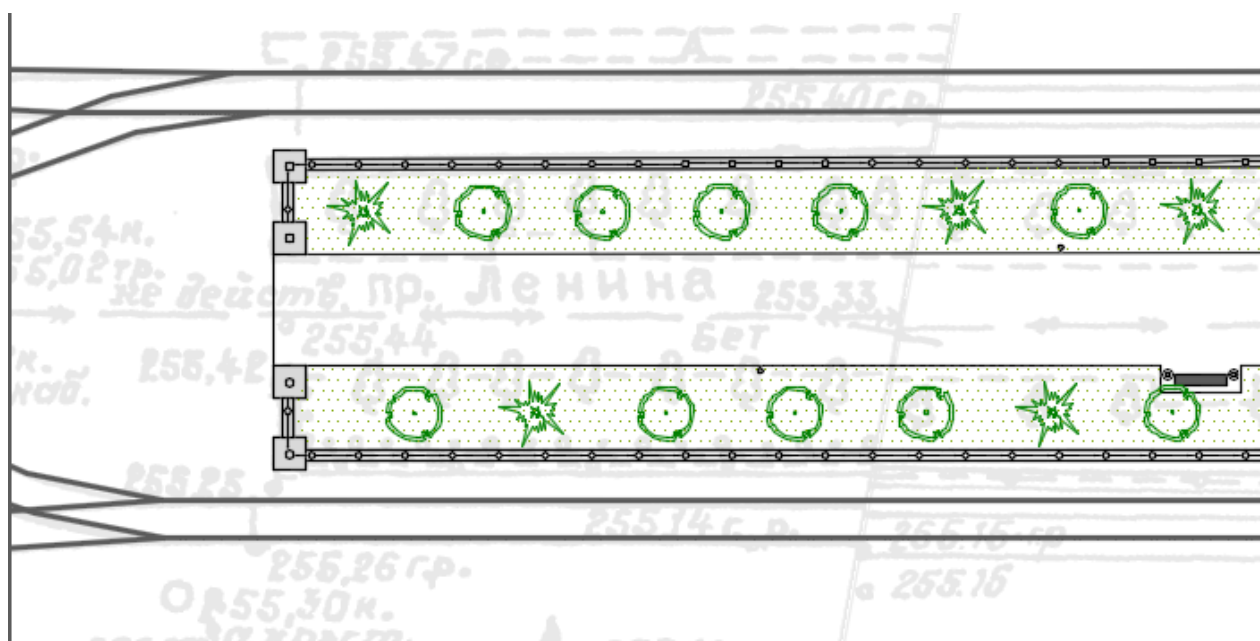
Схема посадки древесных насаждений на бульваре на пр. Ленина (западная
